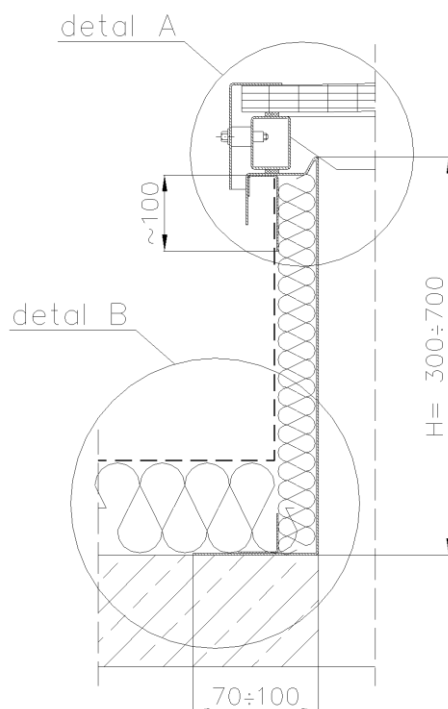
Sposób posadowienia kłapy mcr PROLIGHT DVP na dachu – rozstaw łączników.
